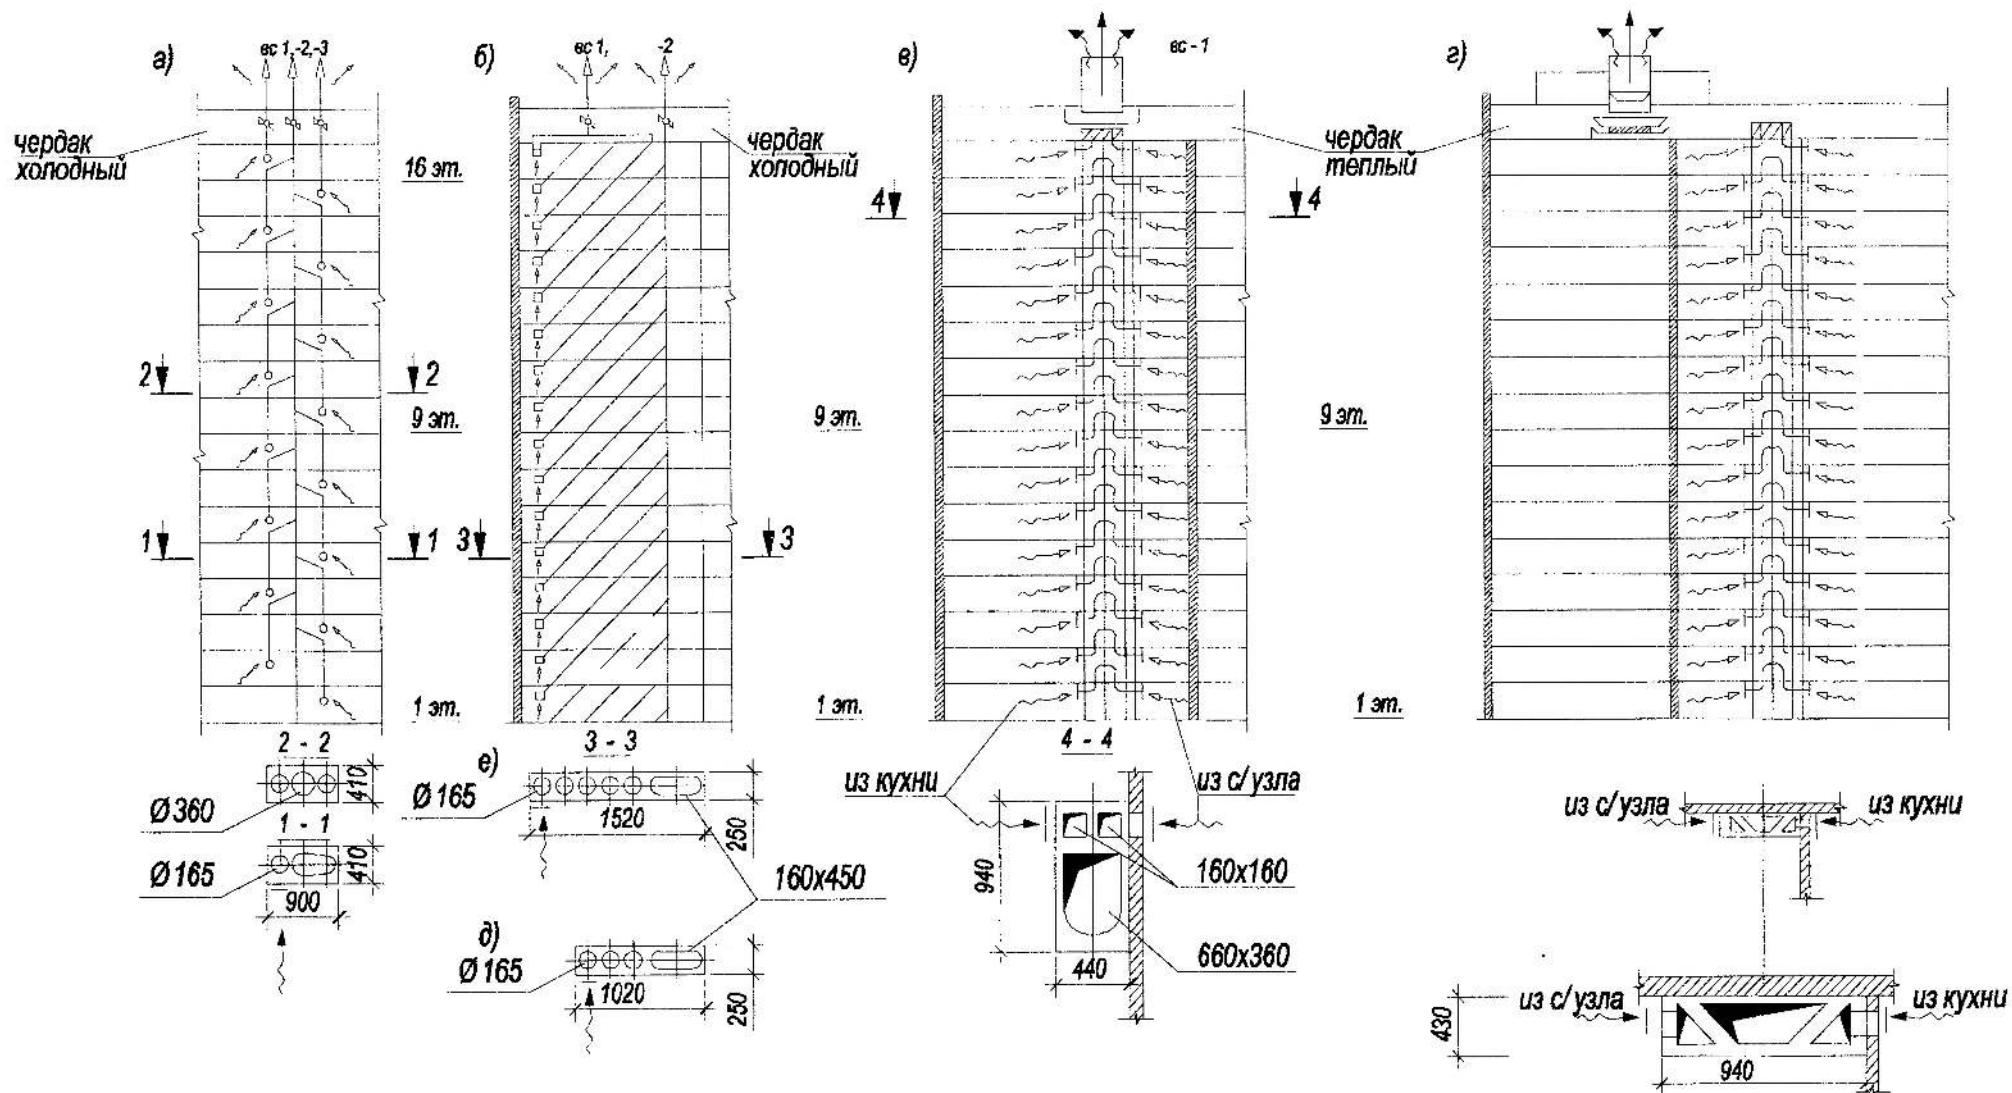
Варианты решения вытяжной естественной вентиляции помещений жилого дома высотой 9-16 этажей (а – вертикальные каналы-спутники в бетонных блоках; б – наклонные каналы-спутники в бетонных перегородках-панелях; в и г – вертикальные каналы-спутники в бетонном блоке, служащем сразу для помещений кухни и санузла одной квартиры; е – вентблок-перегородка для вентиляционных помещений здания высотой более 12 этажей; д – вентблок-перегородка для вентиляционных помещений здания высотой от 9 до 12 этажей)
